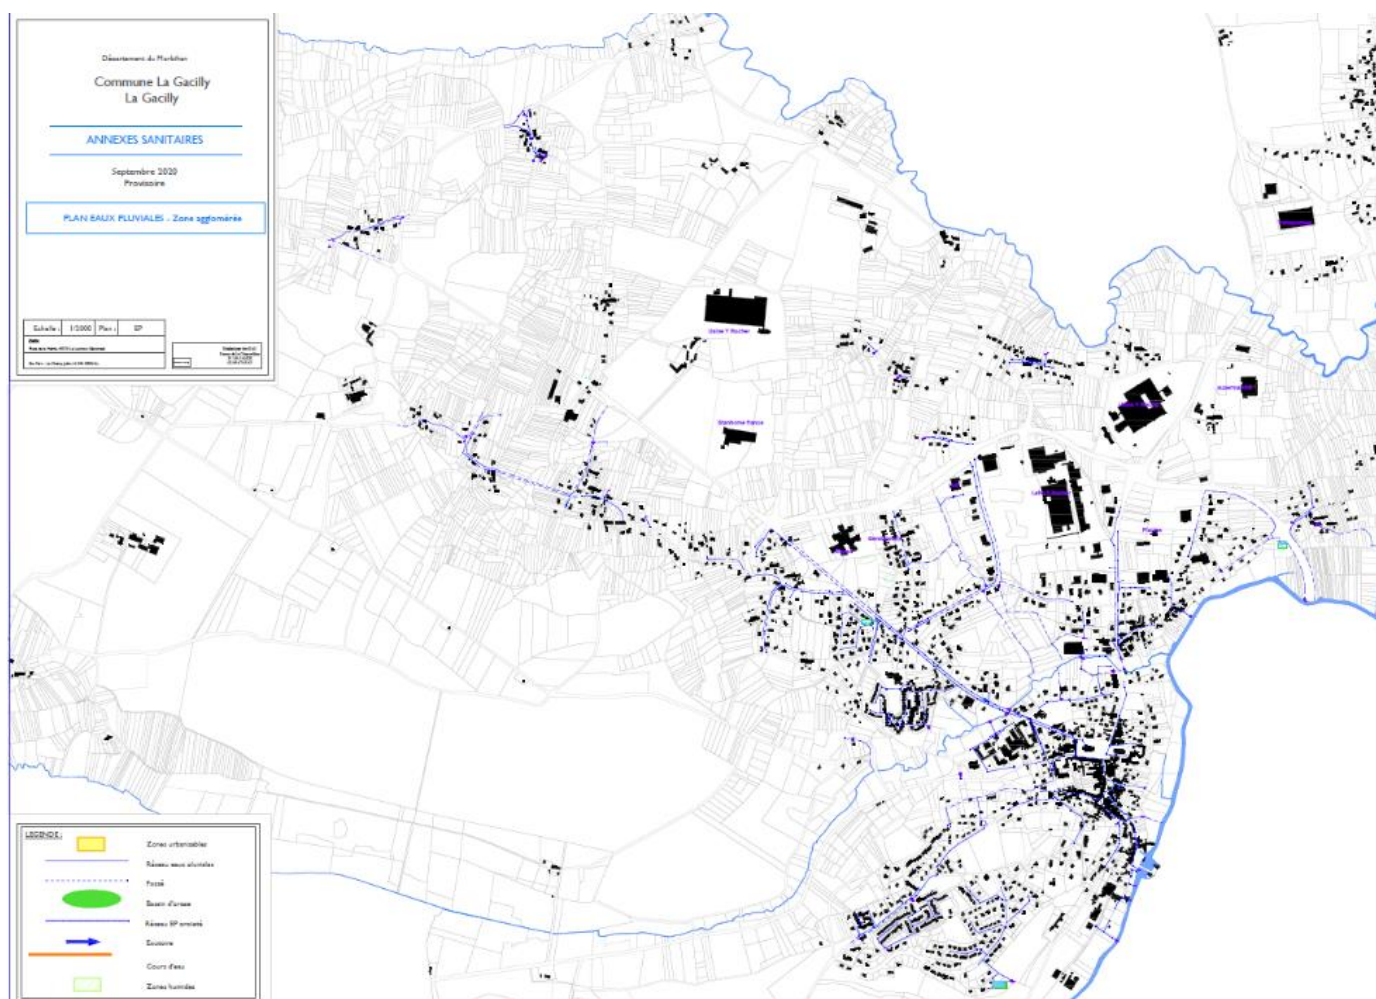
Plan d'évacuation des eaux pluviales de la Gacilly
